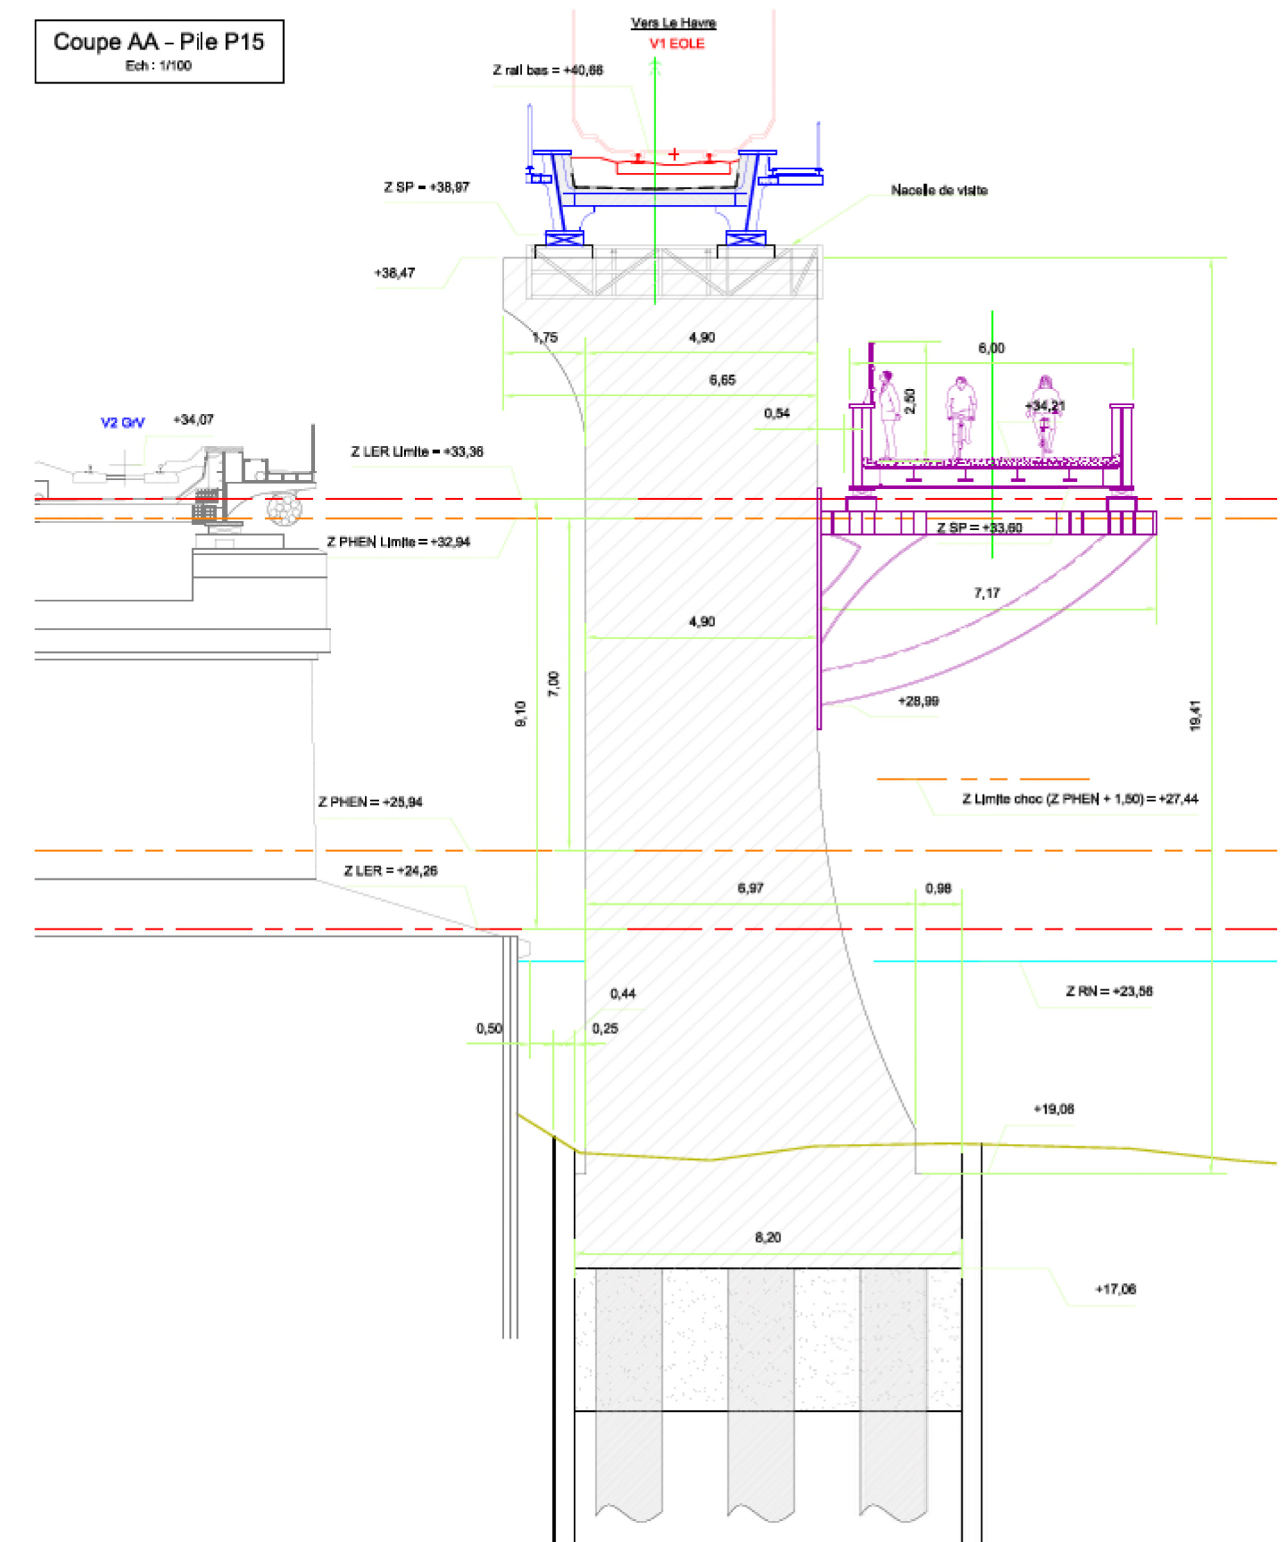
Vue en coupe de la pile P15 : bras de Marly (bras gauche)
